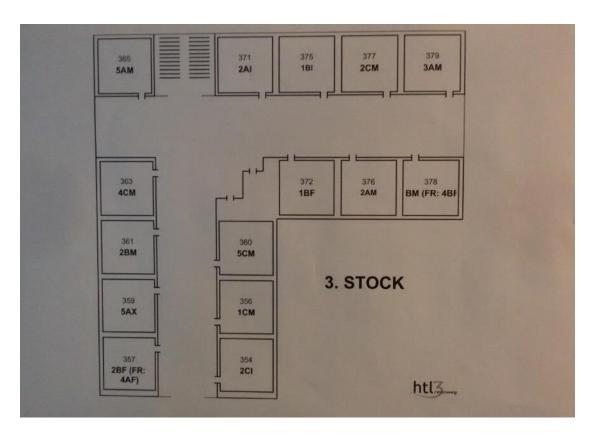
Raum Plan 3. Stock (Foto des Originals)
